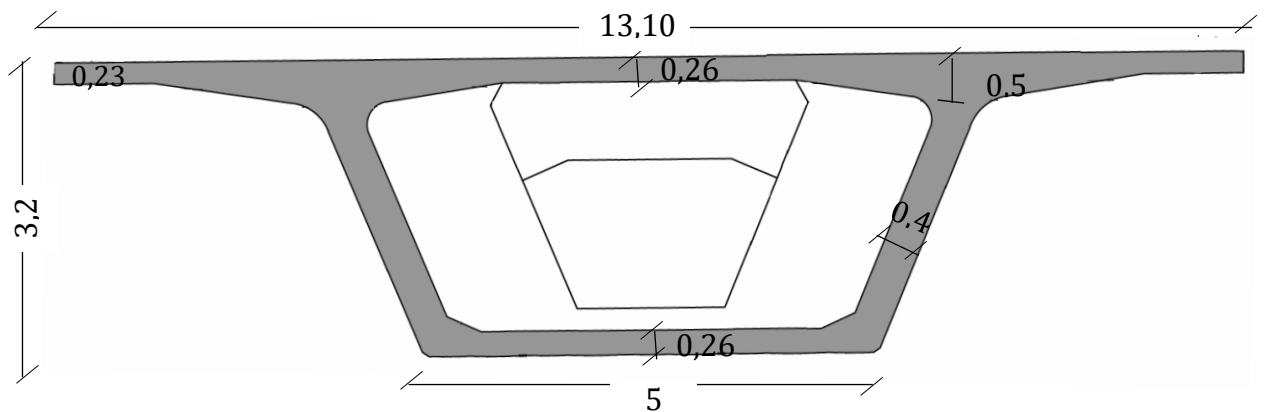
Coupe transversal (coupe 04) du voussoir sur tête-culé (VSC).
